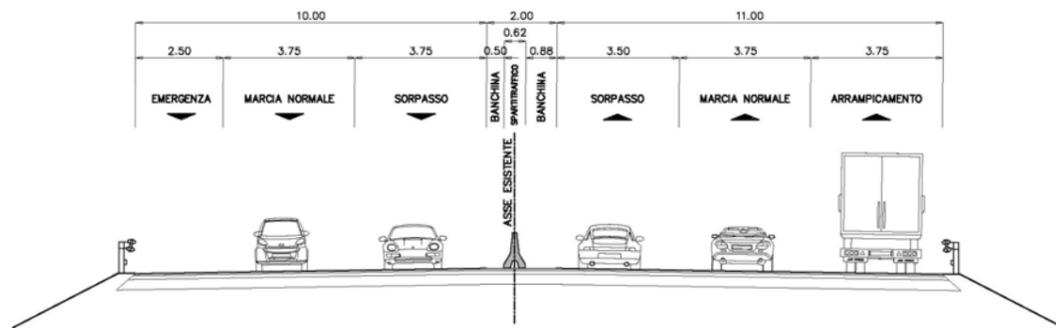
Sezione tipo piattaforma autostradale esistente con corsia di arrampicamento.
